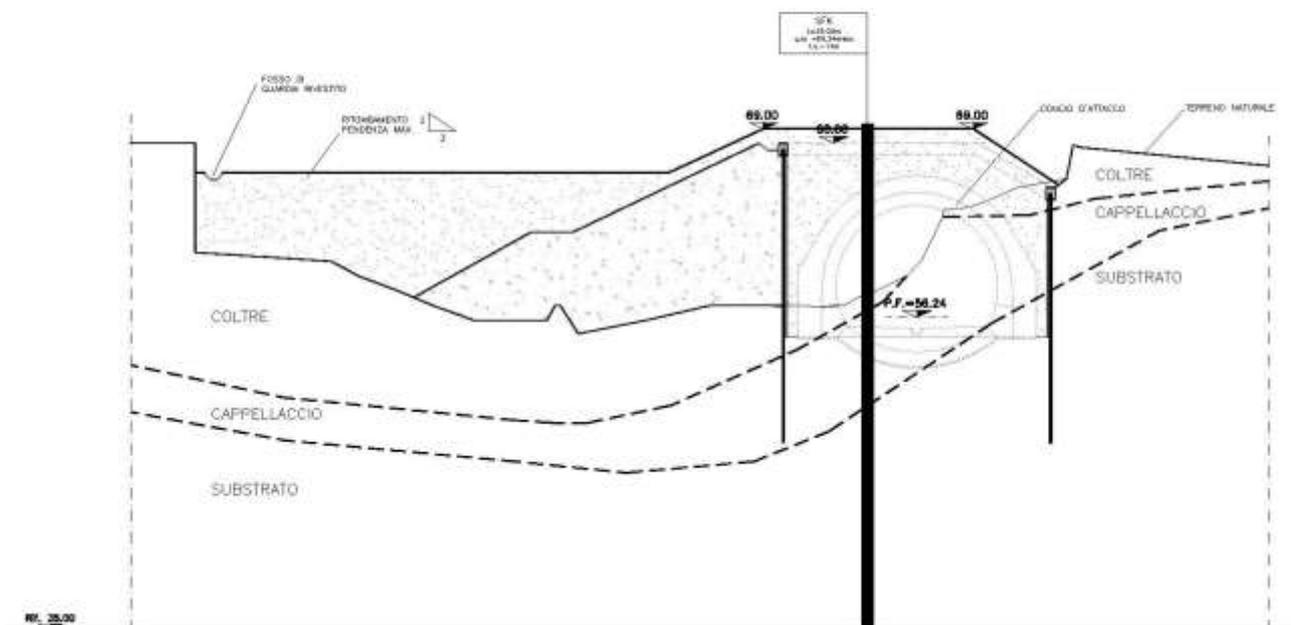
Ricostruzione stratigrafica imbocco: profilo in asse alla linea e sezione imbocco GA/1A
